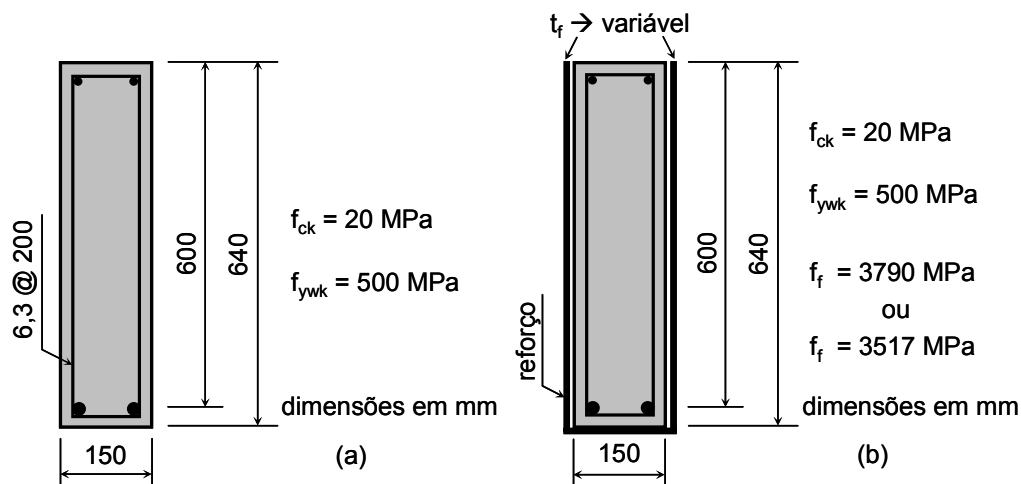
Propriedades geométricas e mecânicas utilizadas nos exemplos: a) viga de concreto armado; b) viga reforçada.
